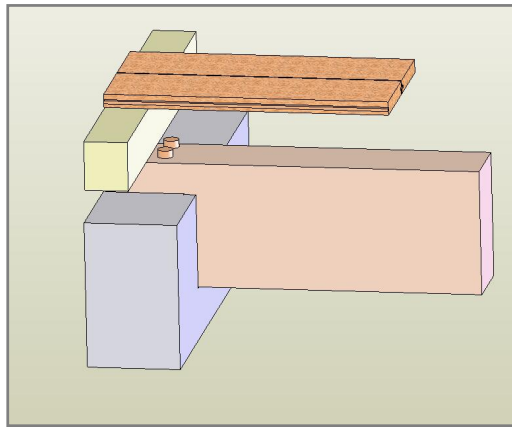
Exemplos de ligações numa montagem estrutural de um pavimento.
